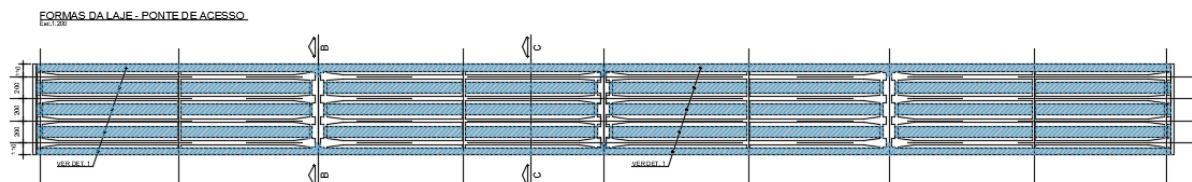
Planta do Tabuleiro – Ponte de Acesso – Lajes com armaduras expostas
